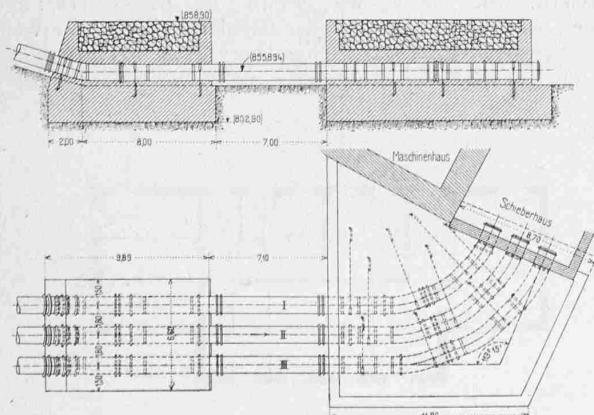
Grundriss und Längsschnitt. — Masstab 1:400.
